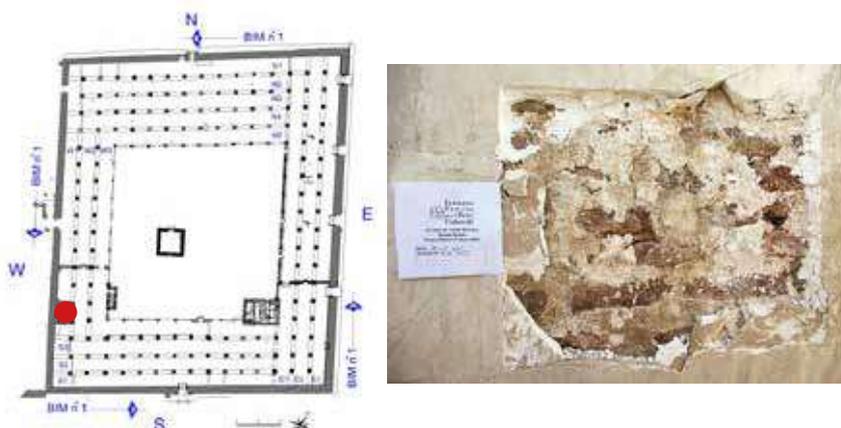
Minareto Ovest, parete Est, campione nr. MWEW0601
